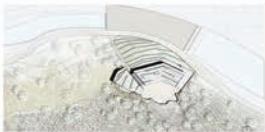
Plan de situație - AMFITEATRUL "STONE NEST" DIN WEIHAI
